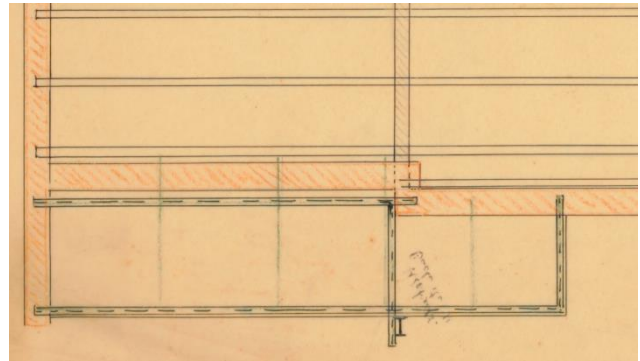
Constructietekening staalconstructie balkon zuidgevel (Rietveld 1924)
